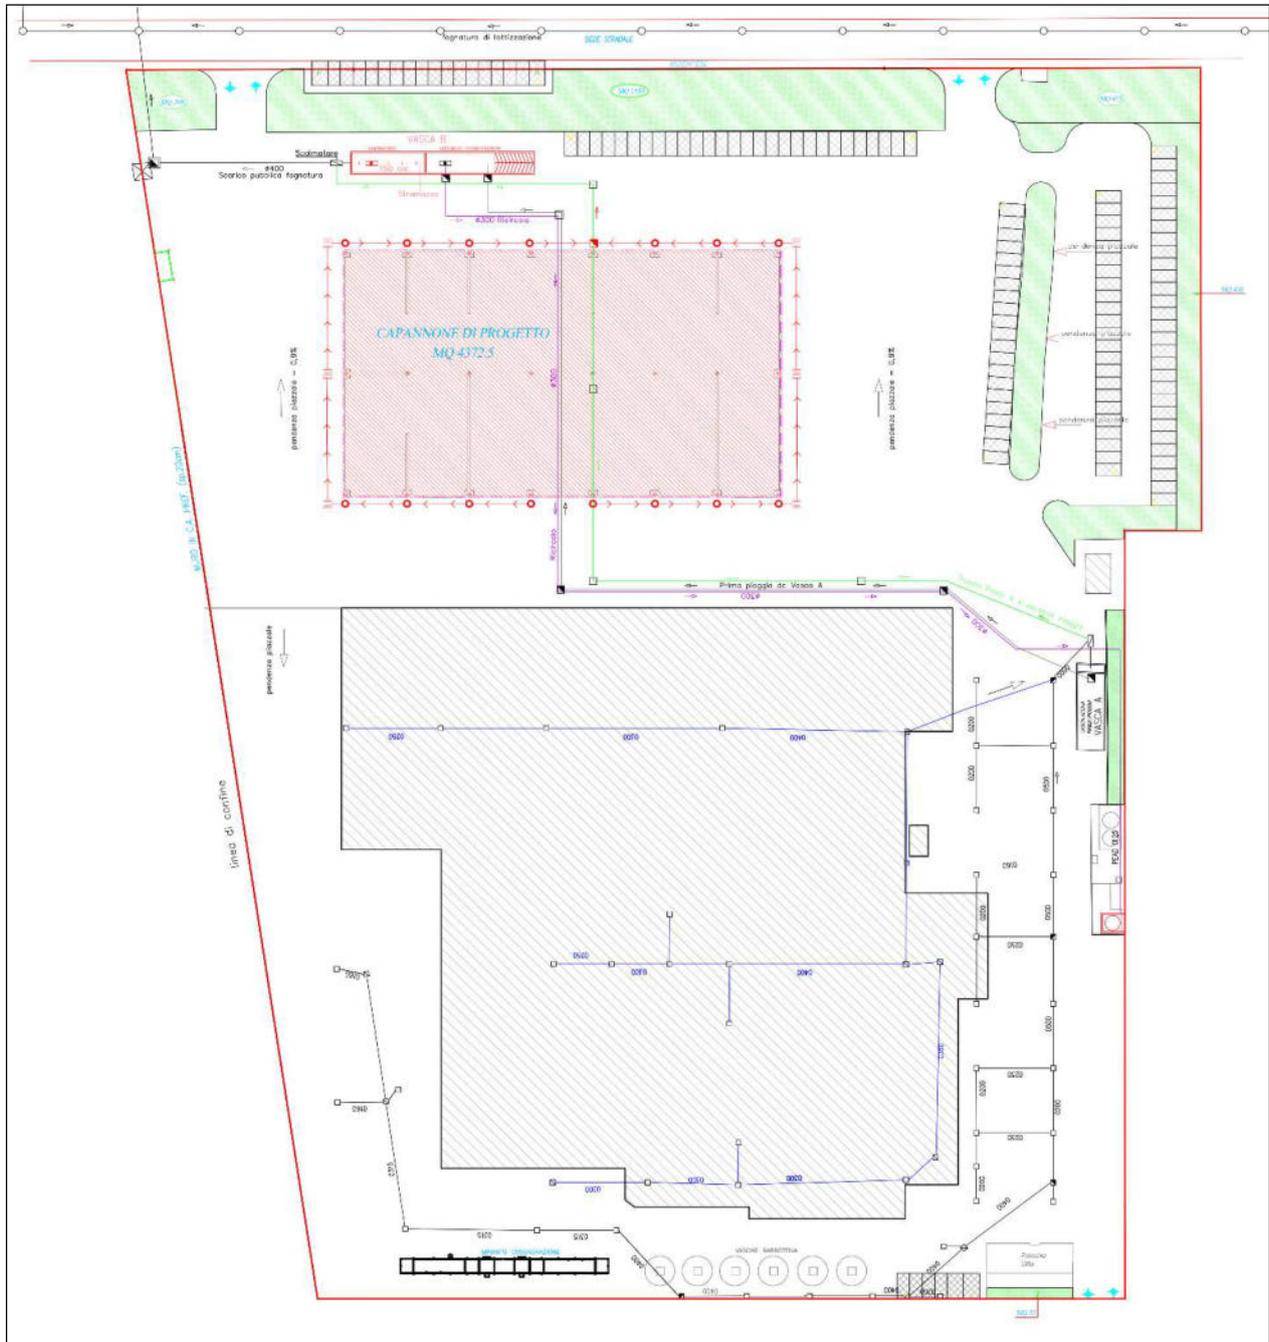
Estratto da Planimetria di Progetto – Permesso di costruire
